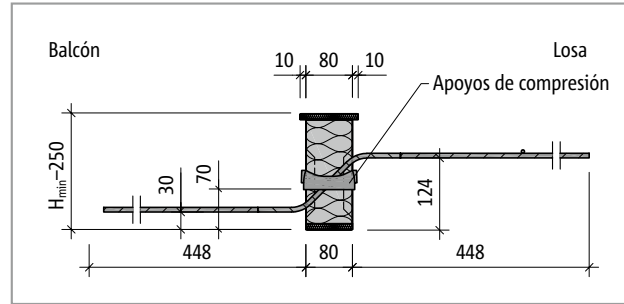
Schöck Isokorb® T tipo Q-V6: Sección del producto
